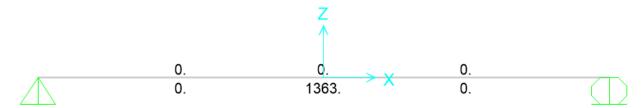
Área de refuerzo longitudinal requerido (en mm²)
